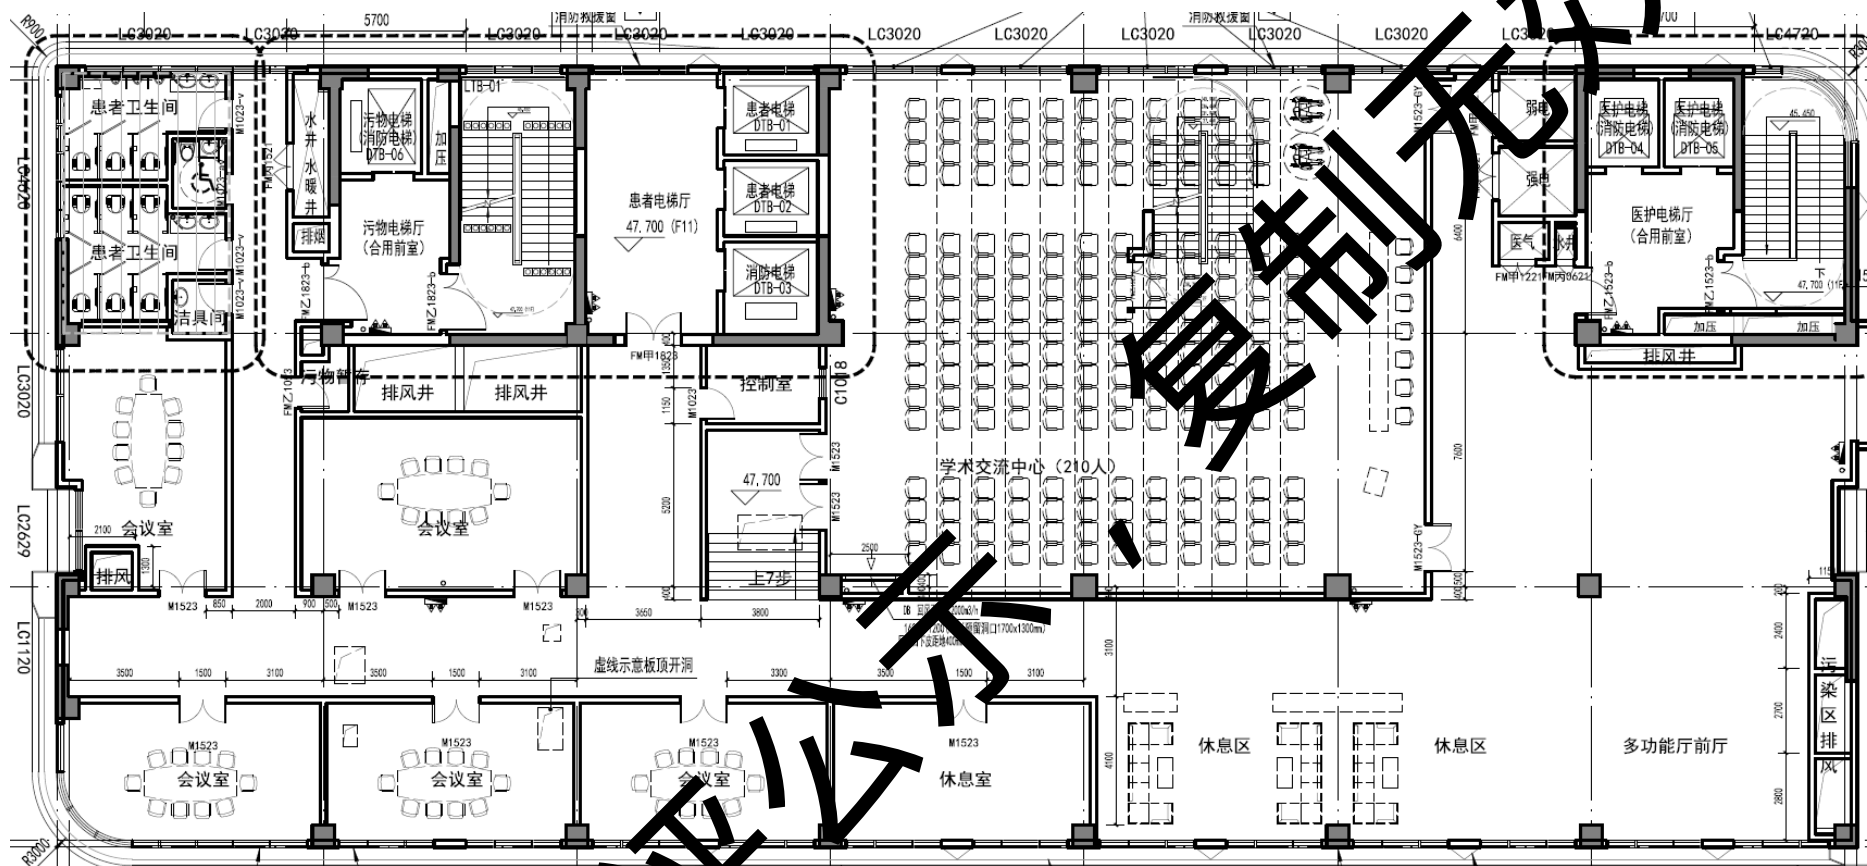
本项目新建应急中心楼 11F 平面布置图
